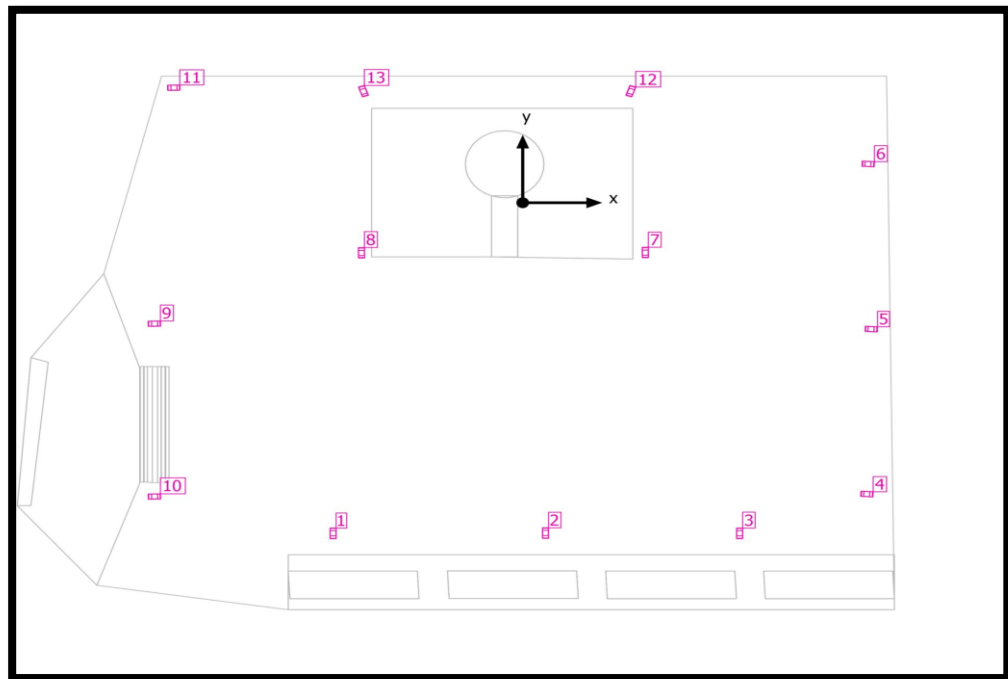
Plan d'emplacement des luminaires sur le jardin ROYAL
